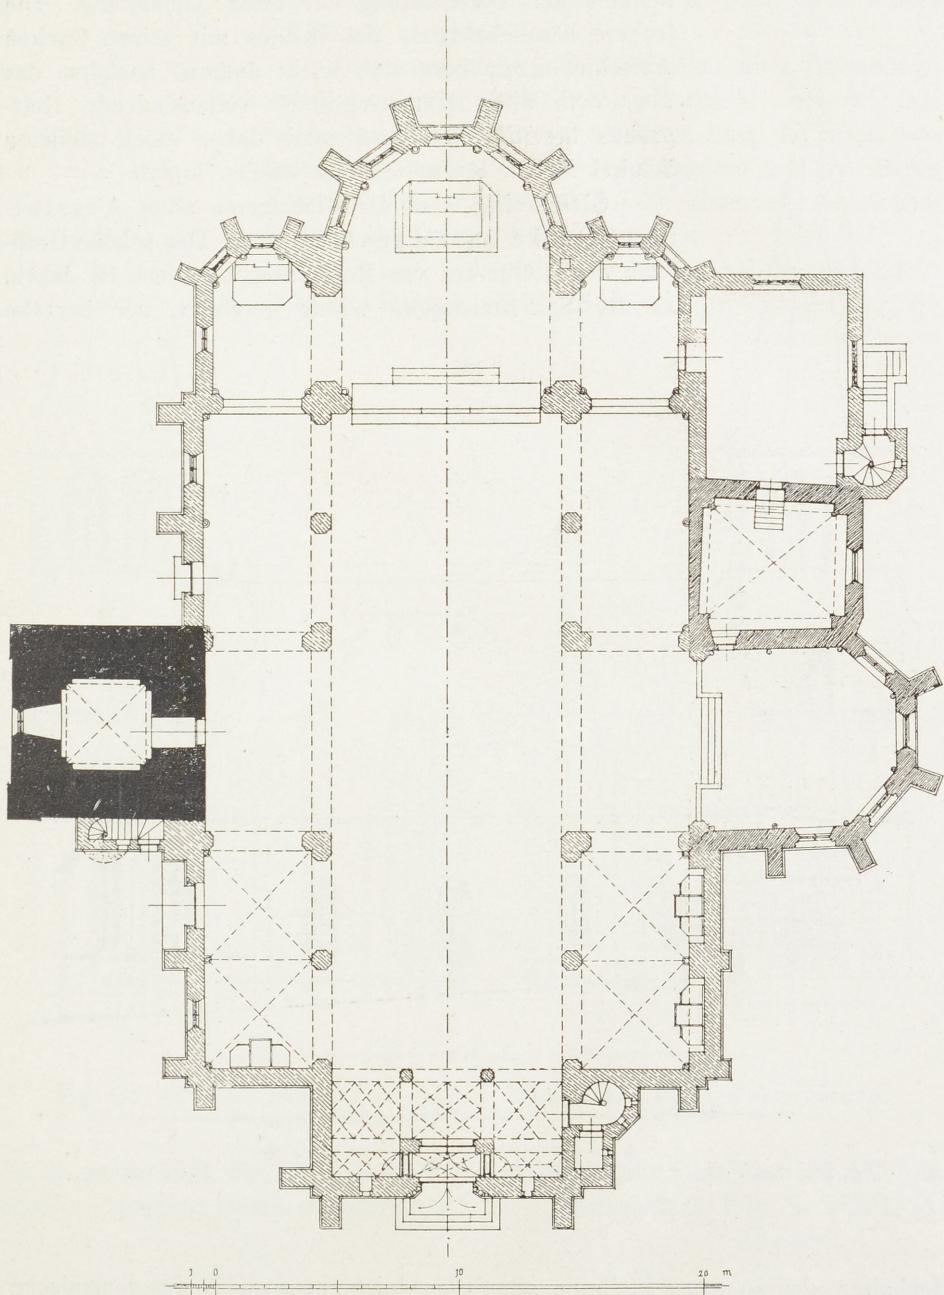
St. Vith. Grundriss der kathol. Pfarrkirche nach der Erweiterung.
